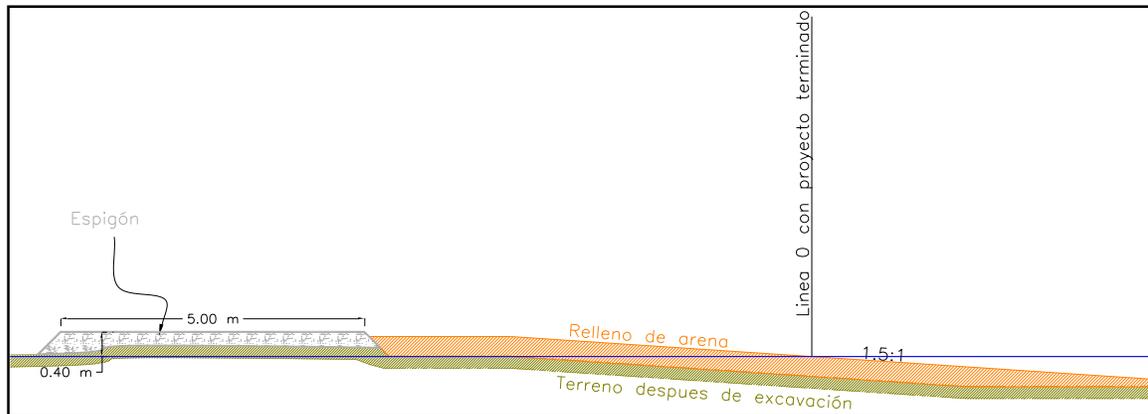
Perfil paralelo a la costa, se observa el espigón y la entrada a la playa.
